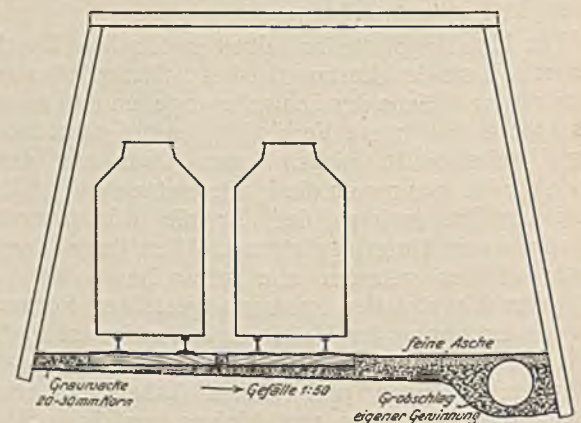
Querschnitt einer Strecke mit zweckmäßiger Gleisbettung und Seitenentwässerung.
